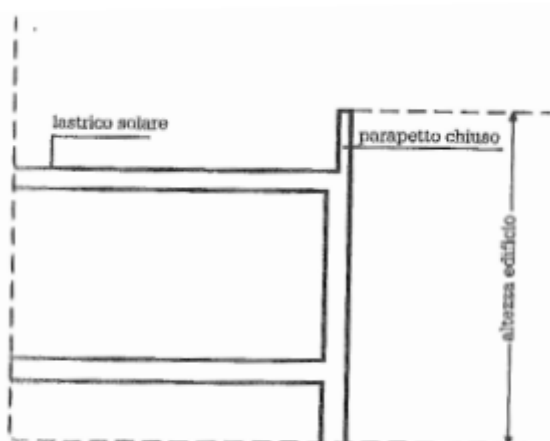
Edificio con copertura piana, parapetto chiuso e lastrico solare
